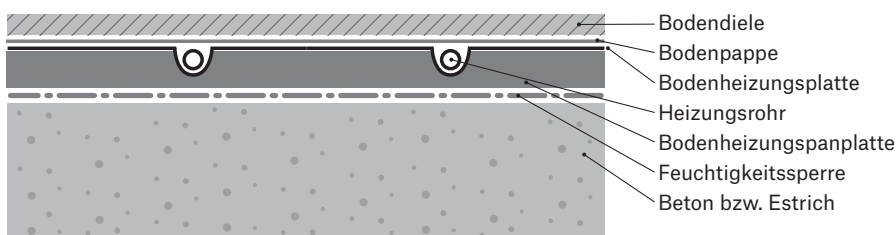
Längsschnitt Heizungsspanplatten auf Beton bzw. Estrich
